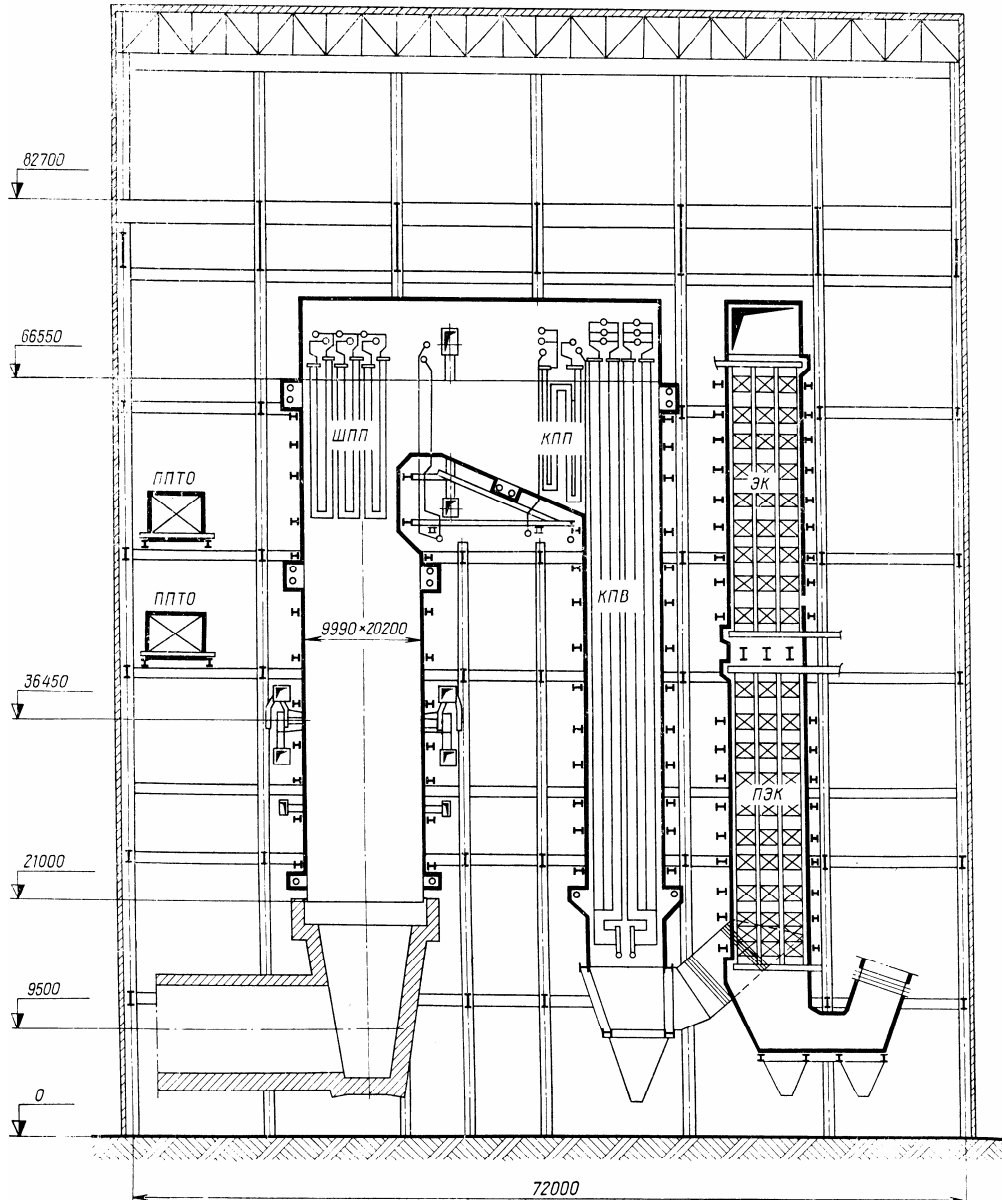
Продольный разрез котла Пп-1000-25-545/542 Г (П-74)
